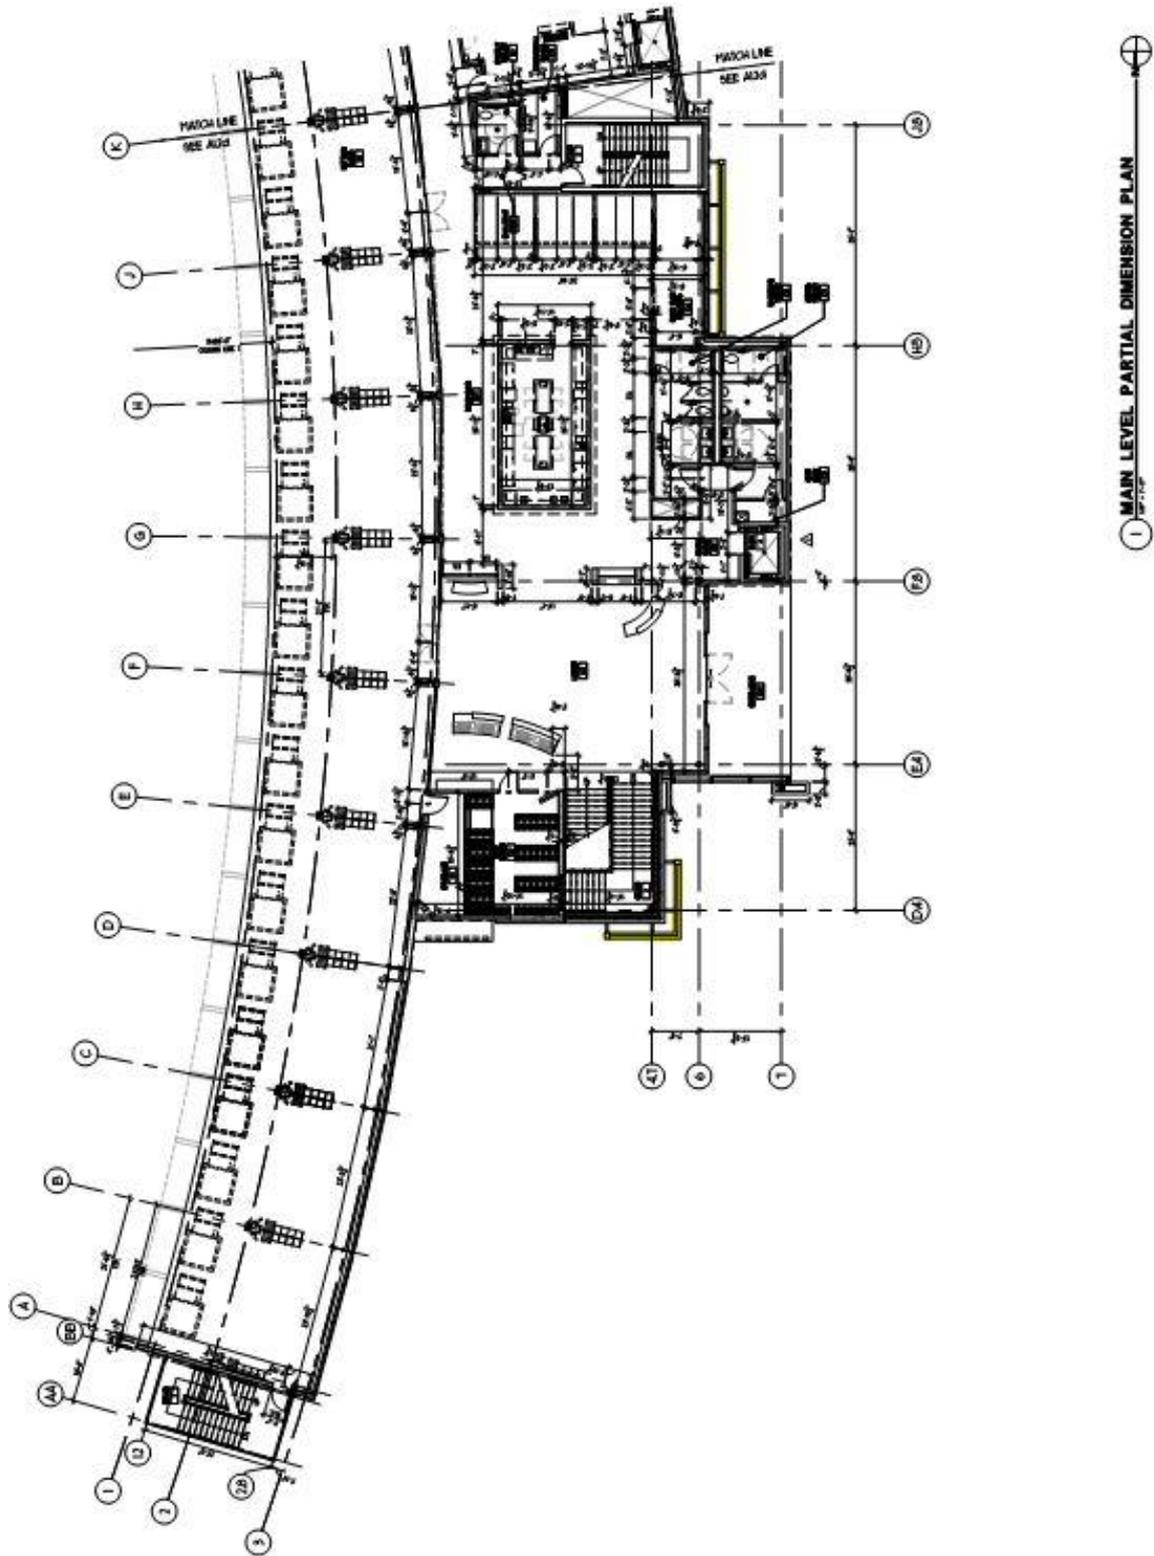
Planta arquitectónica de proyecto. Las áreas resaltadas muestran la ubicación de los paneles de malla metálica.
